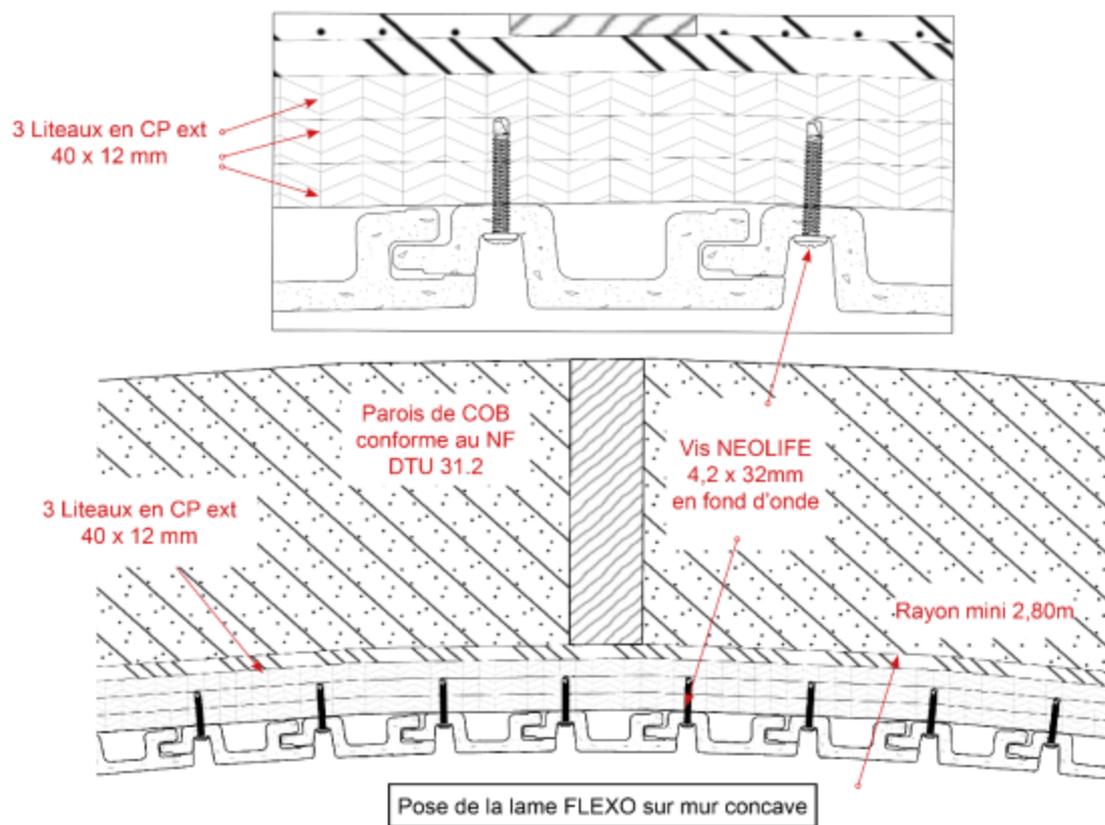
is - Principe de pose du profil FLEXO sur mur concave
